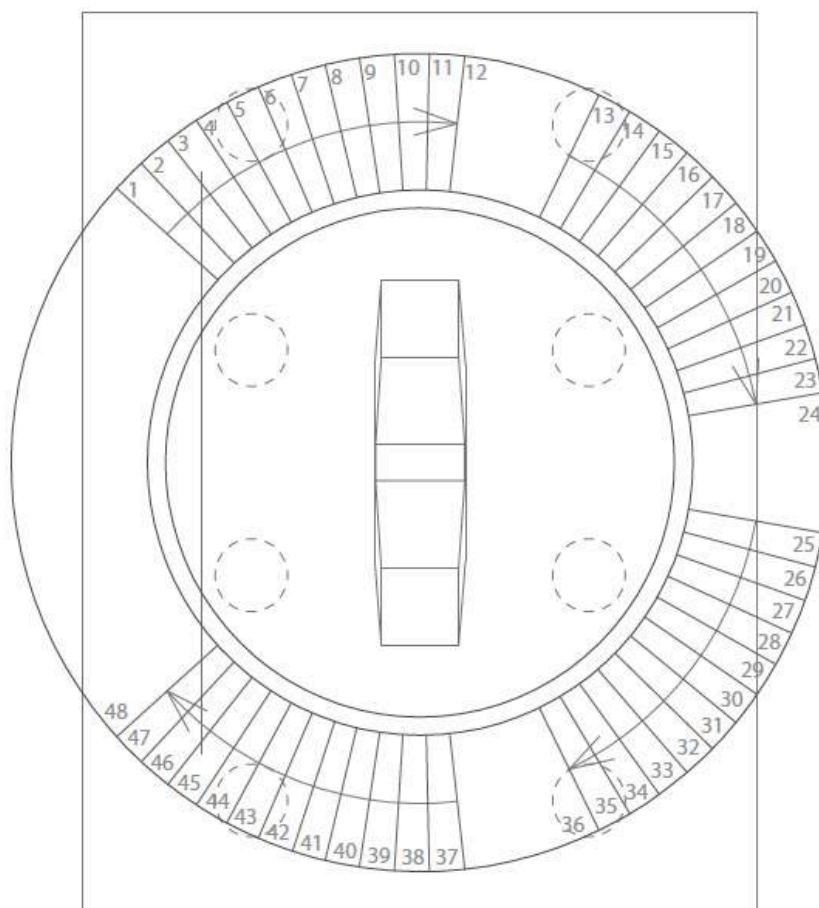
Detalle de la planta de la escalera helicoidal y de la pila de la pasarela
